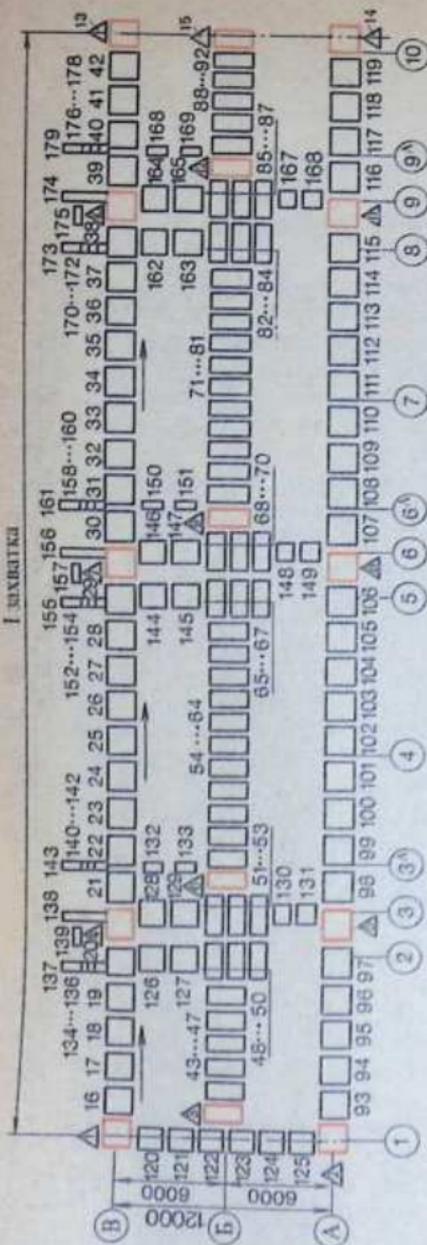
Последовательность монтажа ленточных фундаментов здания (указана цифрами, треугольниками обозначены мадочные блоки)
